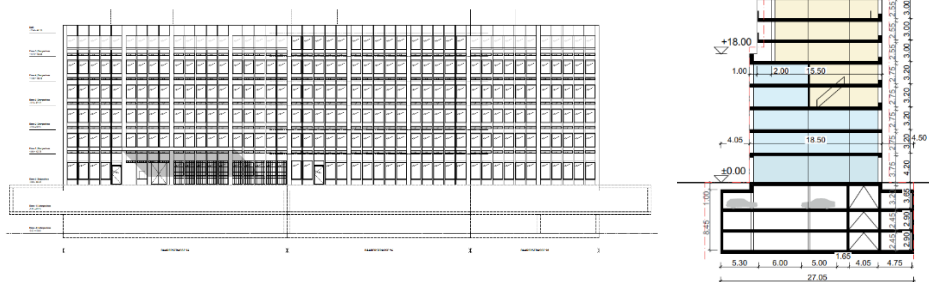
Schnitt Bestandsgebäude / Geplanter Ersatzneubau
